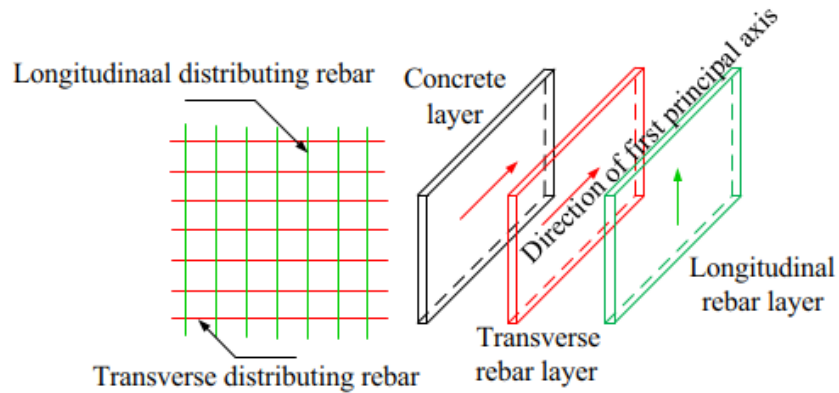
Capas consideradas en un elemento multicapa, imagen obtenida de [74]
